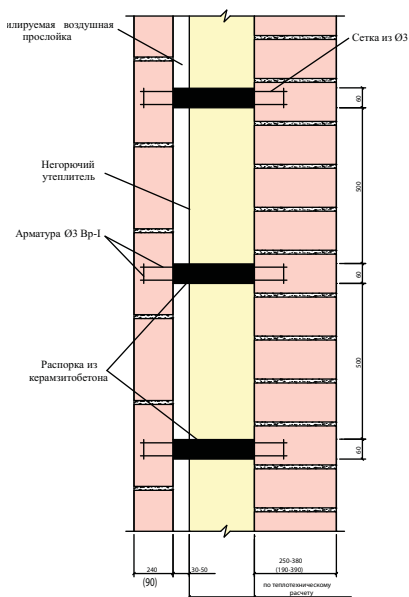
Схема установки керамзитобетонных распорок в уровне низа междуэтажного перекрытия. Сечение 13-13
